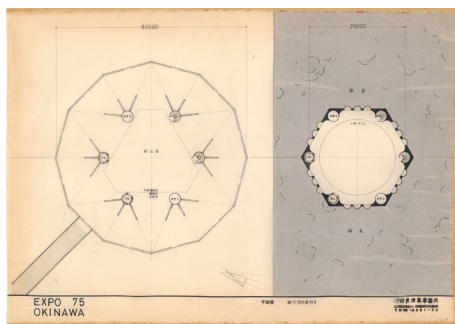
EXPO'75 OKINAWA 平面図 (7-33-78)
